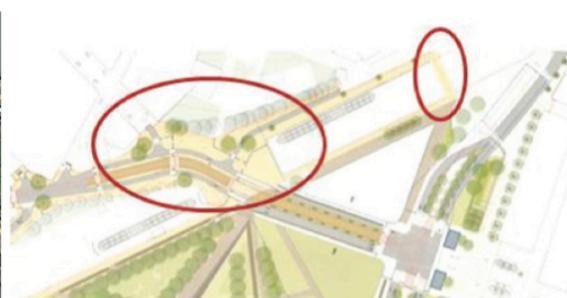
Plan du projet prévu sur la Porte de Ninove
